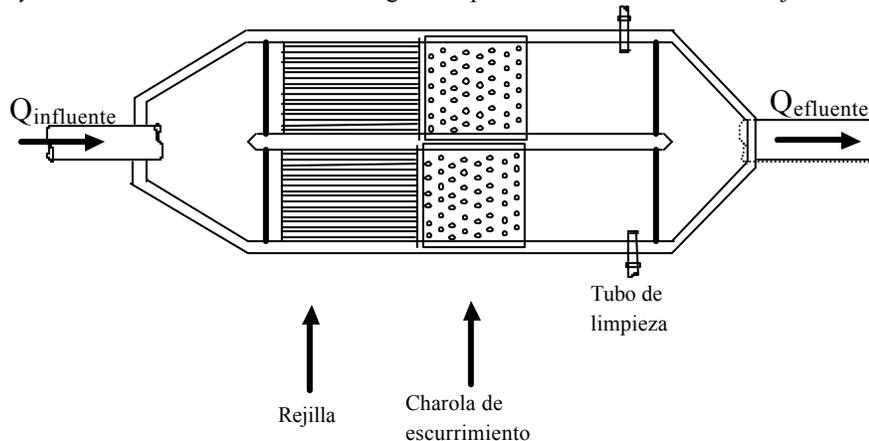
Vista en planta de un sistema manual de rejillas con dos cámaras (Allende, 2001).
